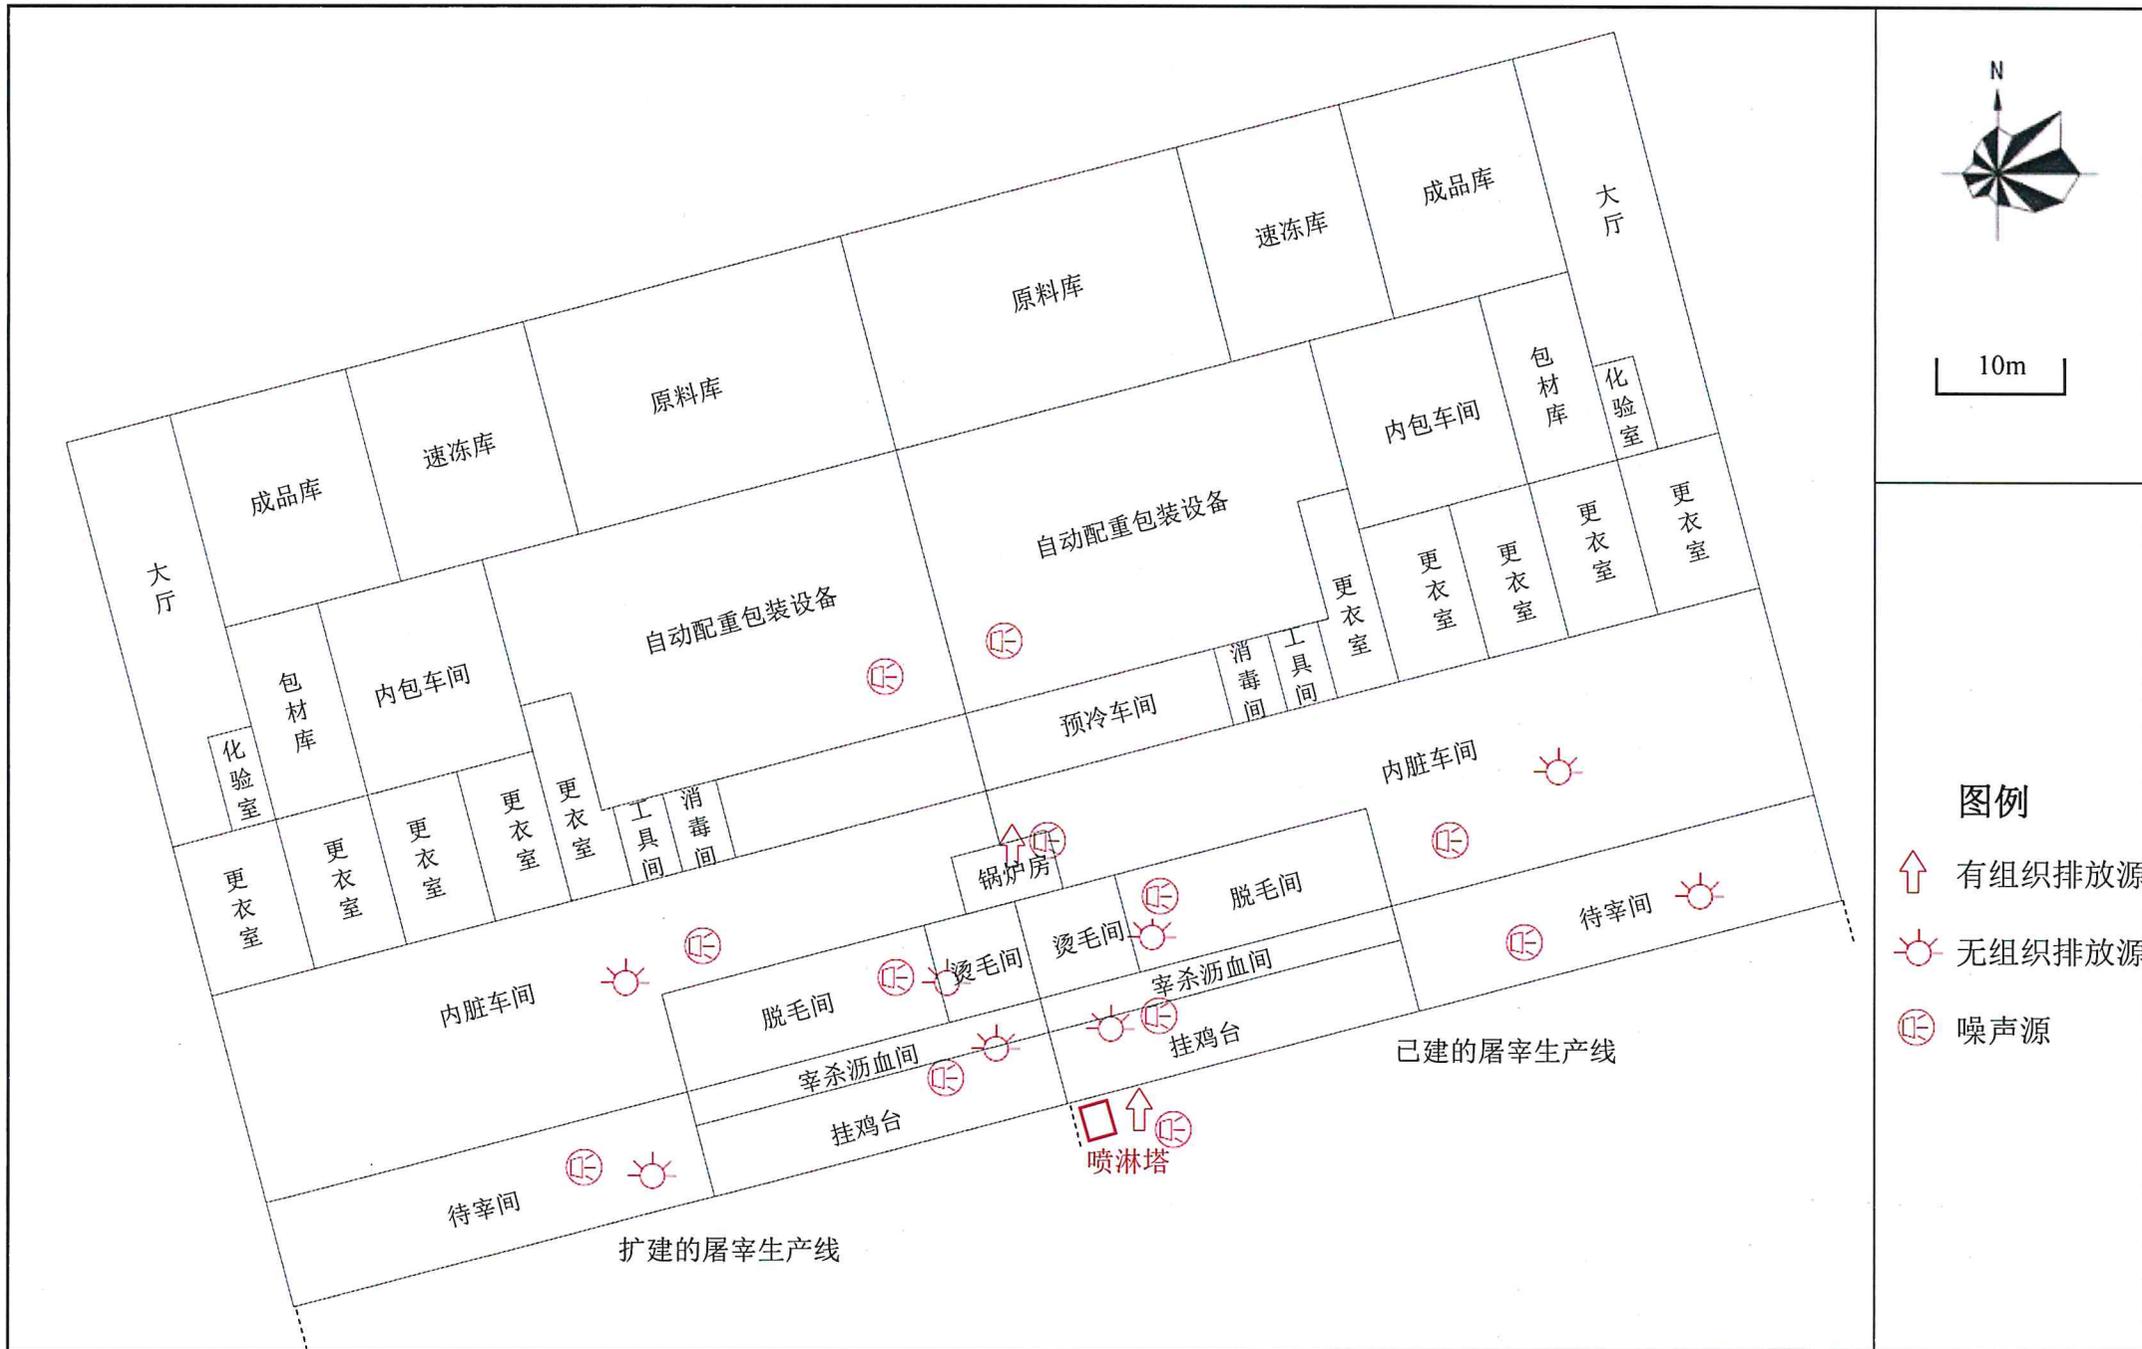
本项目建成后全厂屠宰车间平面布置图 (1F)
